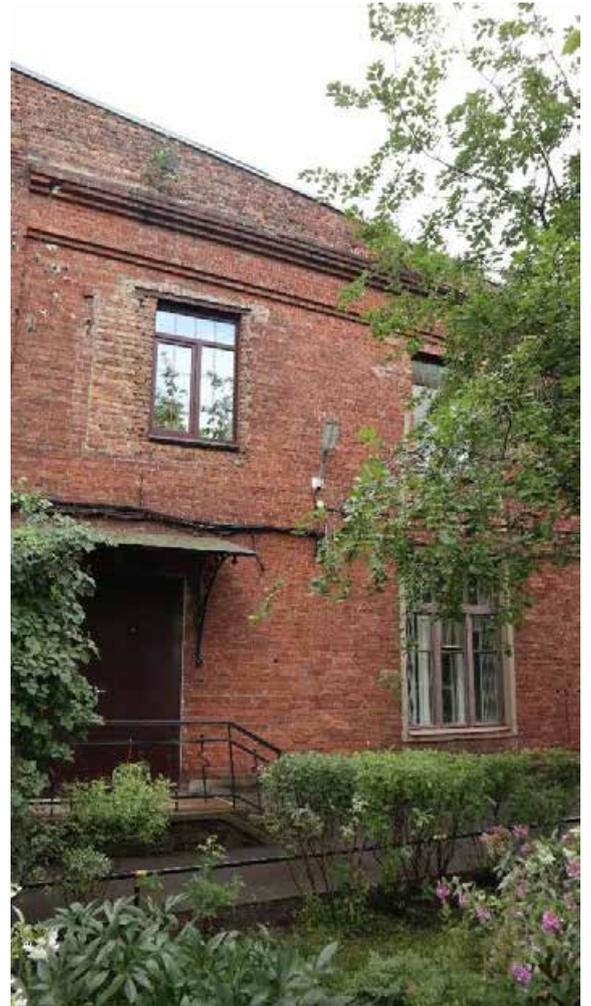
Дворовый (торцевой) фасад, фрагмент.
